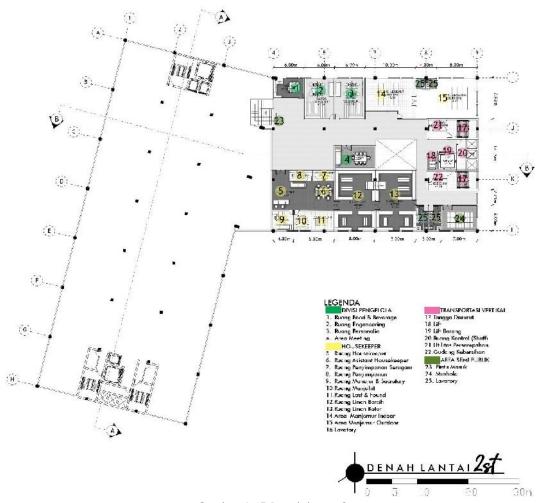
Denah lantai 2 Sumber : hasil rancangan 2023
